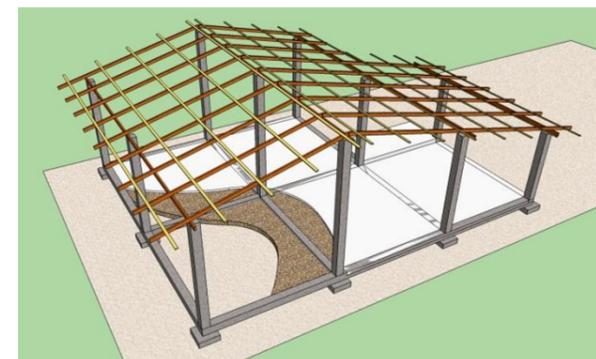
Modelo digital de la estructura de hormigón armado y la estructura de cubierta.
